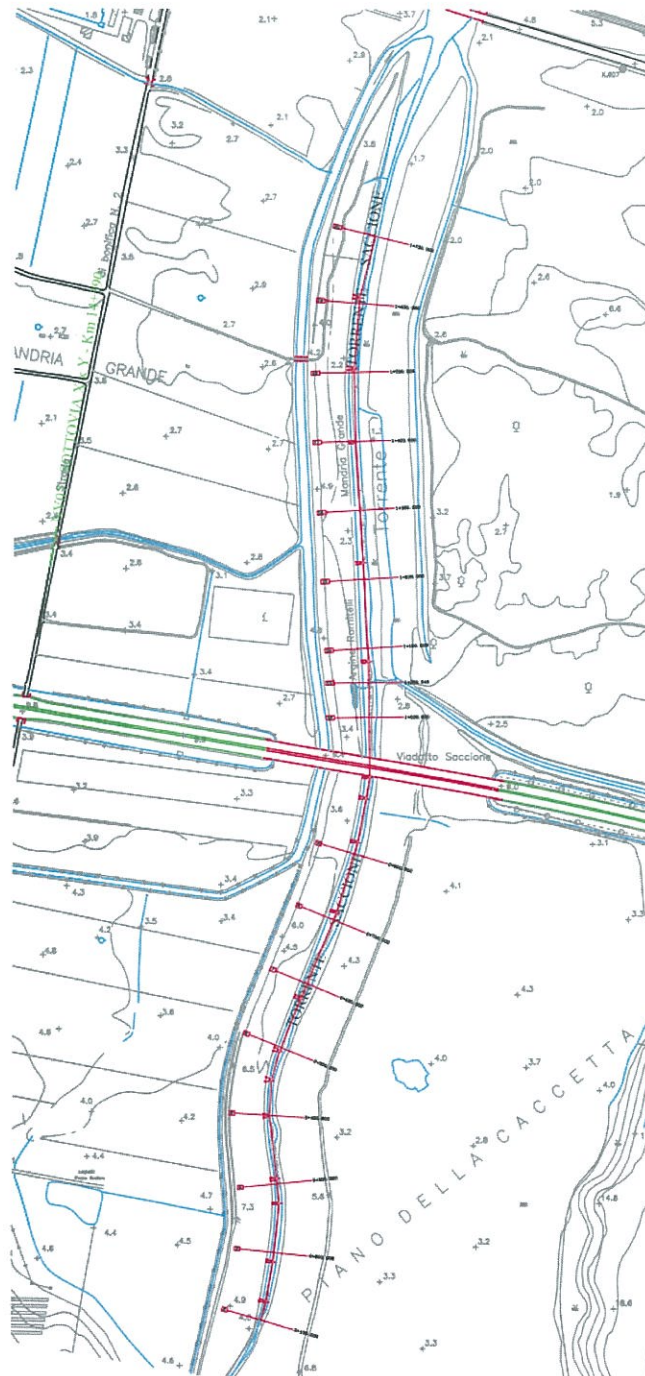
Individuazione planimetrica delle sezioni trasversali
